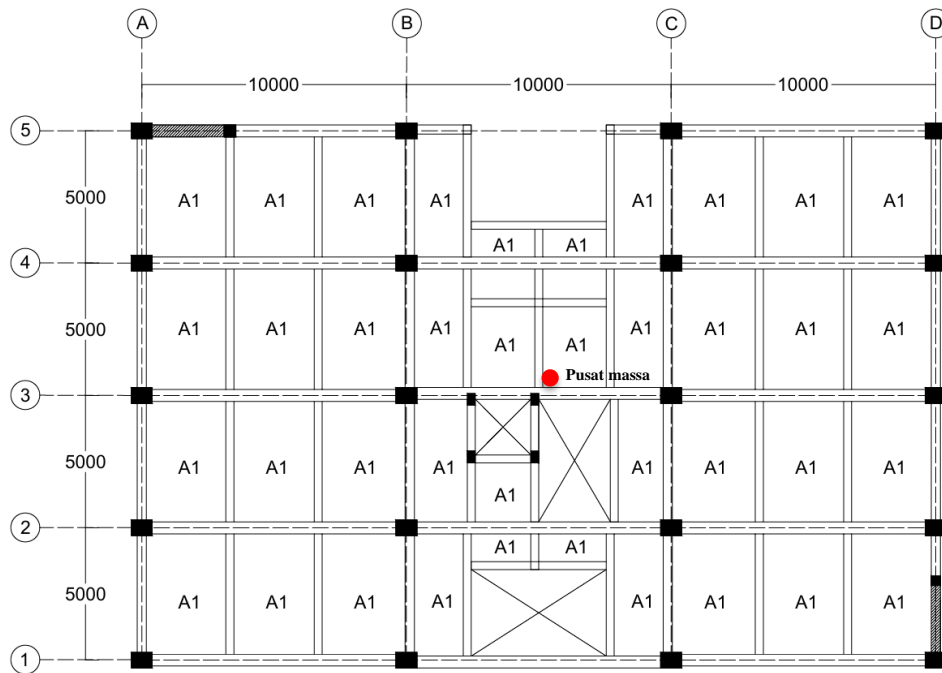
15 Kodefikasi Balok Model 2 Lantai 1 - 3
